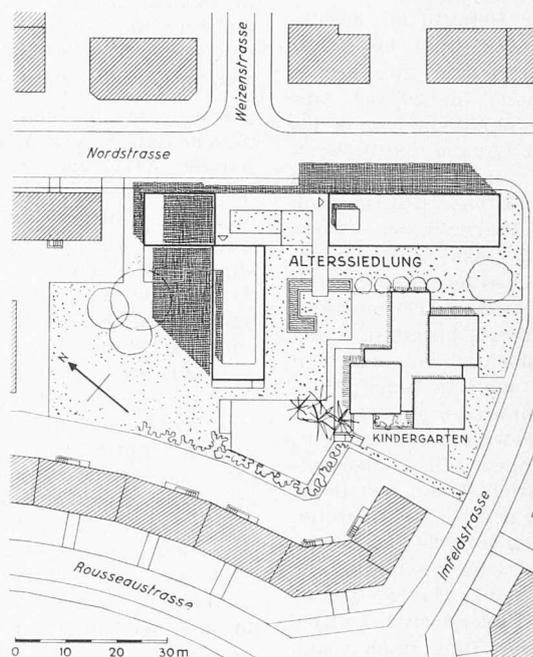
Lageplan 1:1500. SW-NO-Trakt: 8 Geschosse (Hochhaus); NW-SO-Trakt: 4 Geschosse
